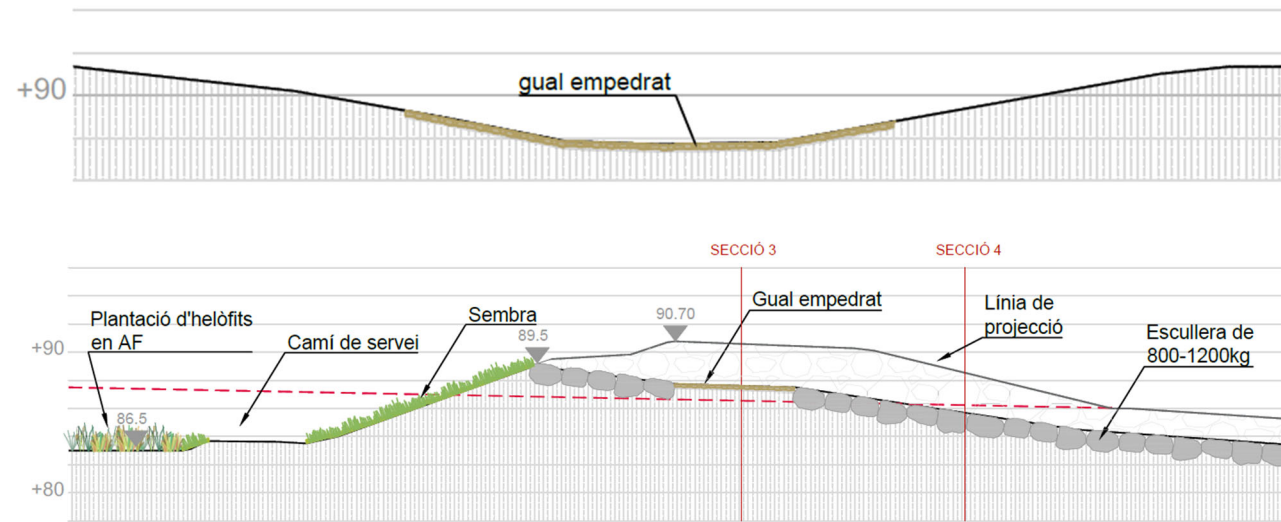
Perfil longitudinal i transversal del gual del sobreexidor de la bassa de laminació
